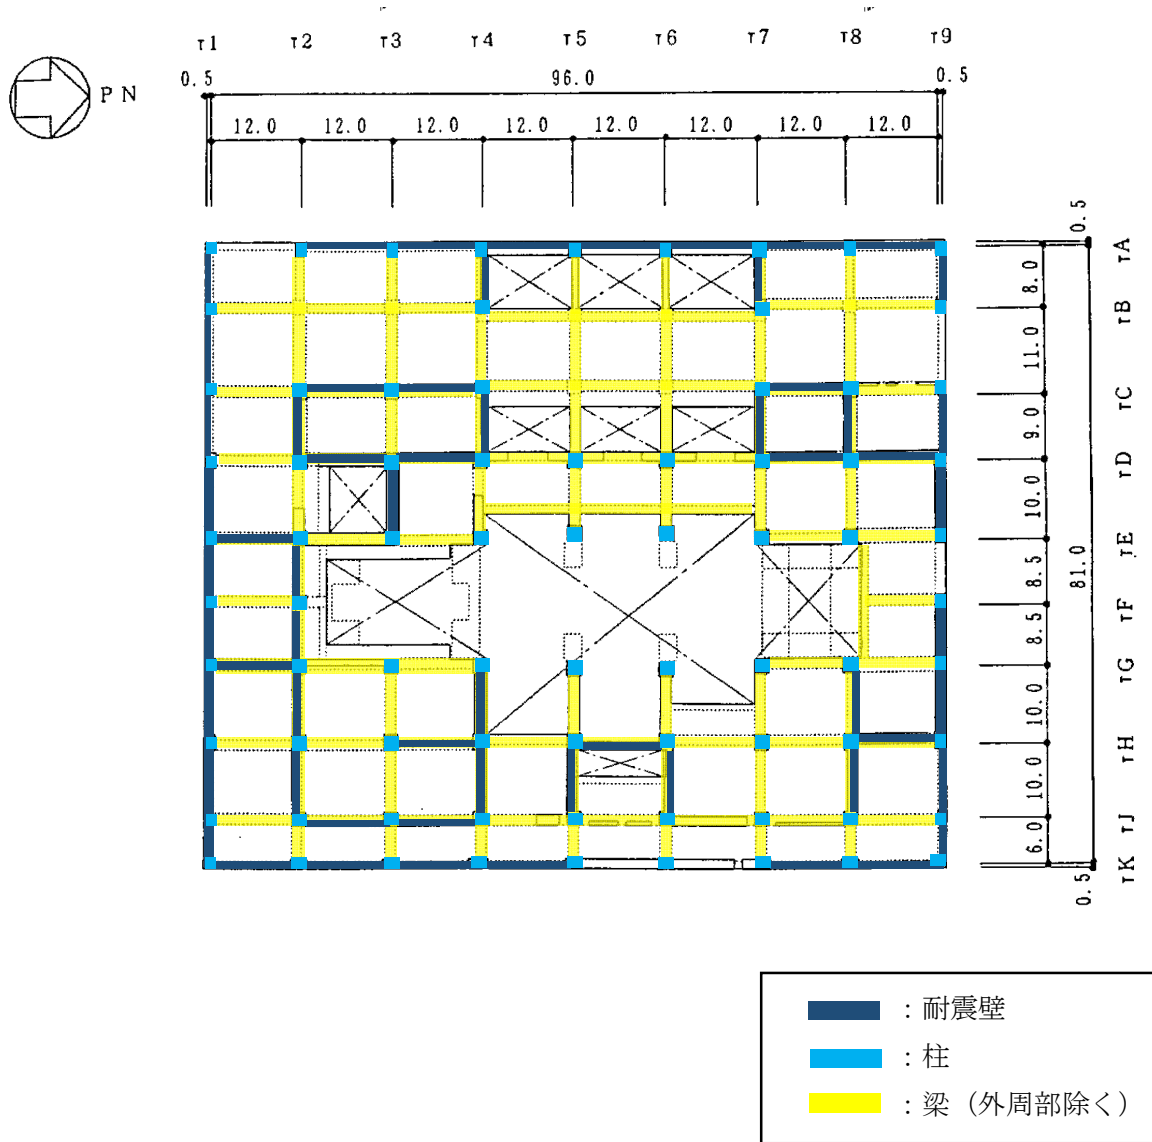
タービン建屋 (6号炉) 1階伏図 (T.M.S.L. 12.3) (単位 : m)
